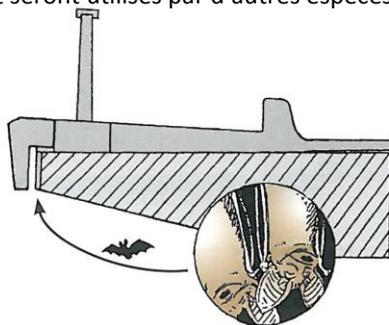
Espace libre entre la corniche et le tablier de l'ouvrage. En apparence des ponts en béton sont peu hospitaliers (vibrations, claquement au niveau des joints de chaussées) mais les corniches sont souvent occupées dès leur construction. En revanche, les nouveaux habillages métalliques n'offrent aucun intérêt pour les chiroptères.
